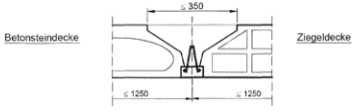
Rippendecke nach Anlage 9, Abschnitt 5
